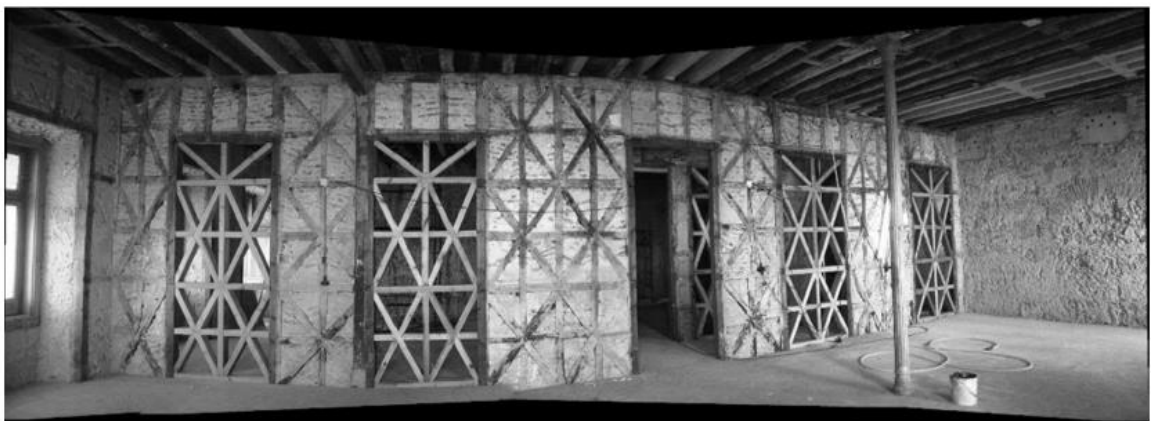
Paredes de alvenaria mista pedra ou tijolo com armação em madeira [42]
